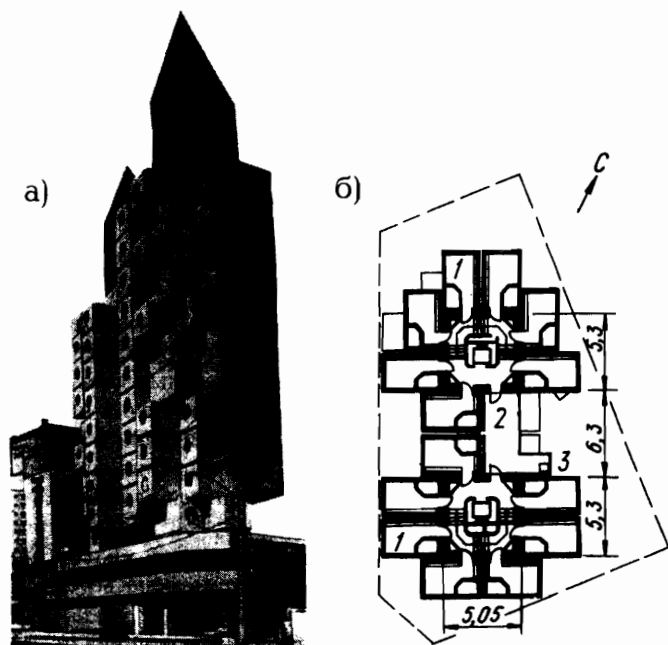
Жилой дом из объёмных блоков в Токио (Япония): а – общий вид; б – план в уровне шестого этажа (в уровне перехода между секциями): 1 – объёмный блок; 2 - переход; 3 – люк открытой пожарной лестницы
